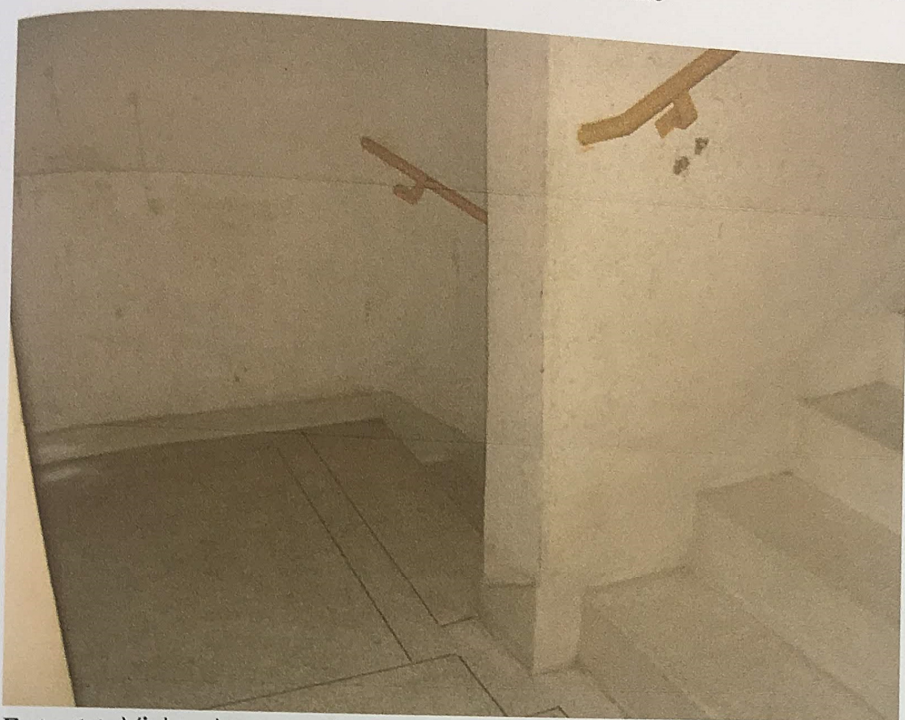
Vista da escada de acesso aos pavimentos do condomínio.
